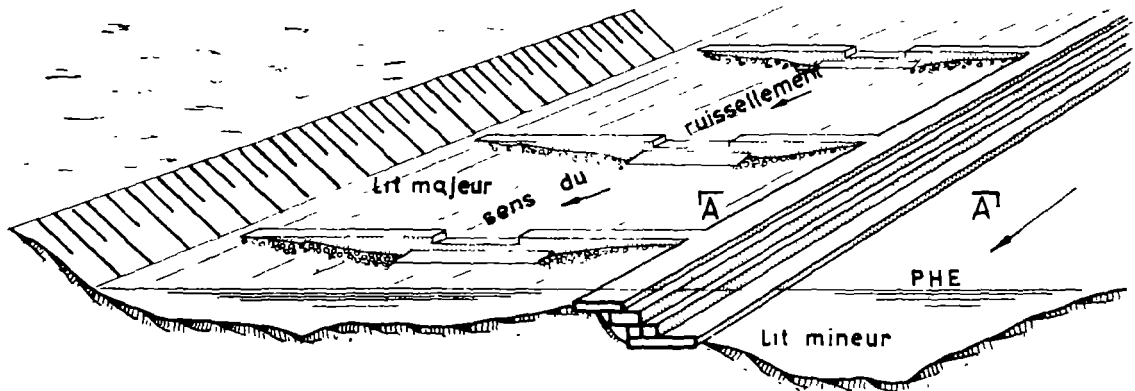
Protection de berge submersible et aménagement secondaire du lit majeur
